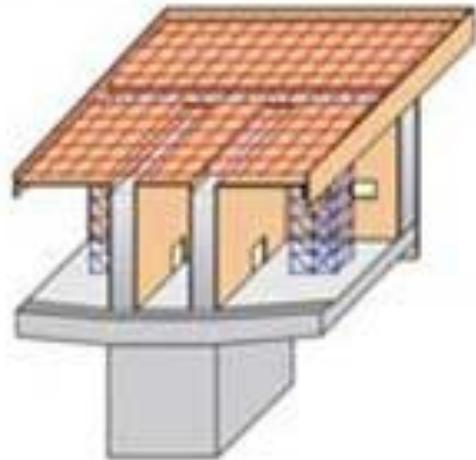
Fase 2. Levantamiento de las paredes que conforman la viga cajón
